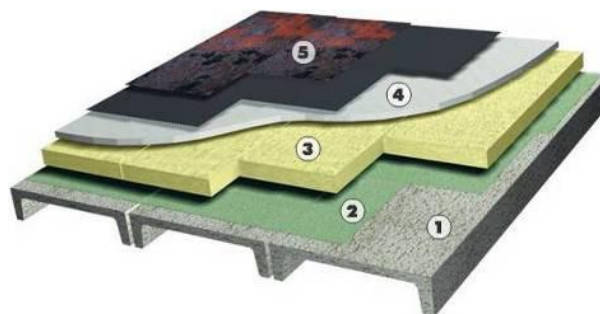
Структура плоской кровли: 1 – плиты покрытия; 2 – слой пароизоляции; 3 – слой утеплителя; 4 – железобетонная стяжка; 5 – слой гидроизоляции (рулонной или наплавляемой)
